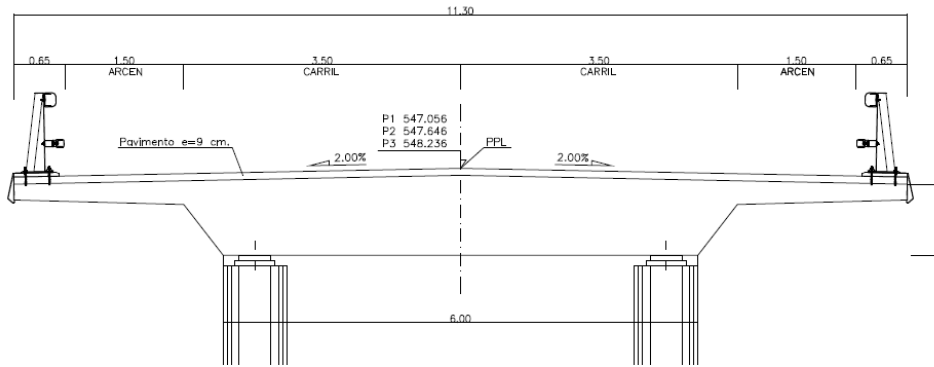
Detalle Estructura 6 y 8 Alternativa 2
